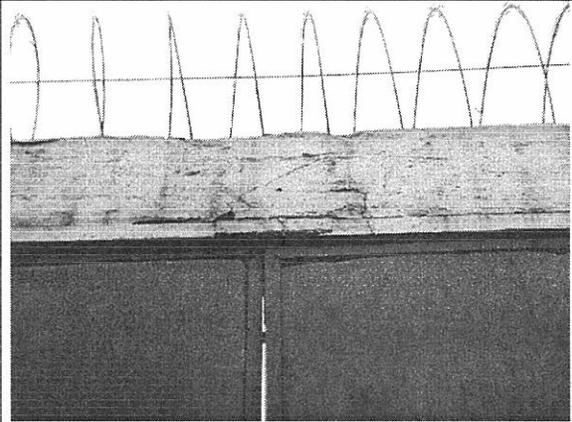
Fisuras en el dintel en el centro de la luz.
